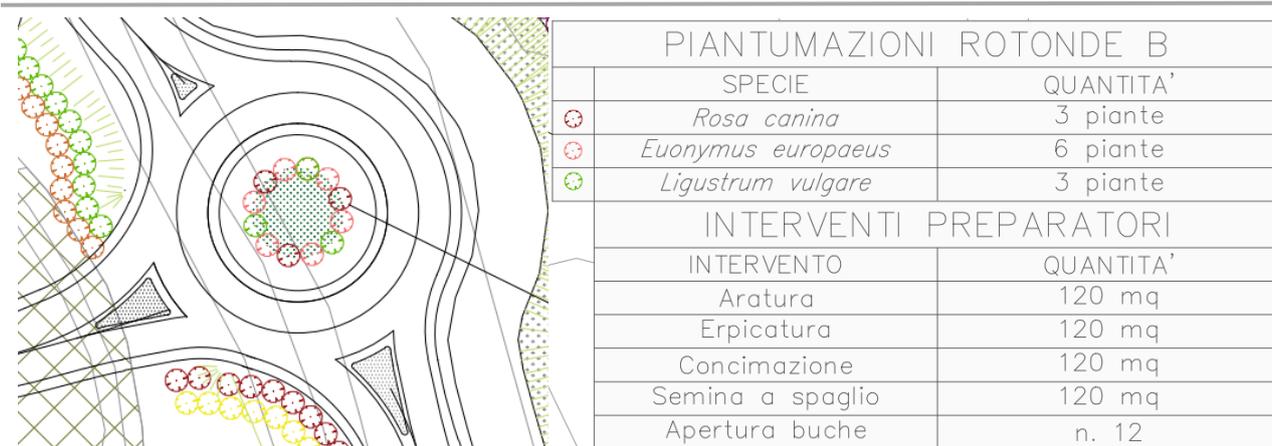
Estratto Elaborato P00_IA00_AMB_PP01 Planimetria opere a verde
